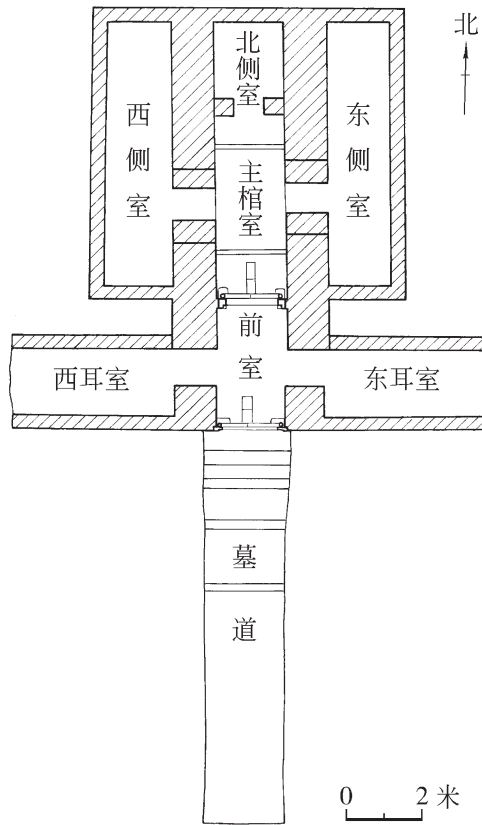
广东省广州市象岗山汉墓平面图 (1/200)
